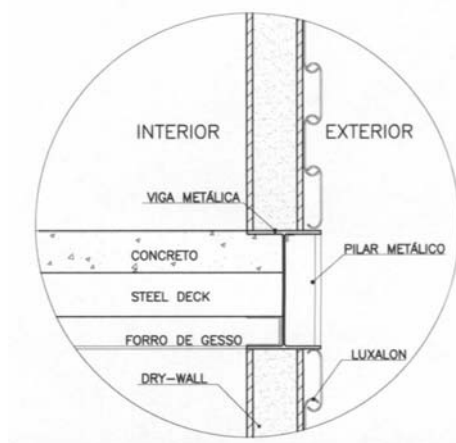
Detalhe do sistema construtivo e revestimentos utilizados no projeto da equipe 1.
